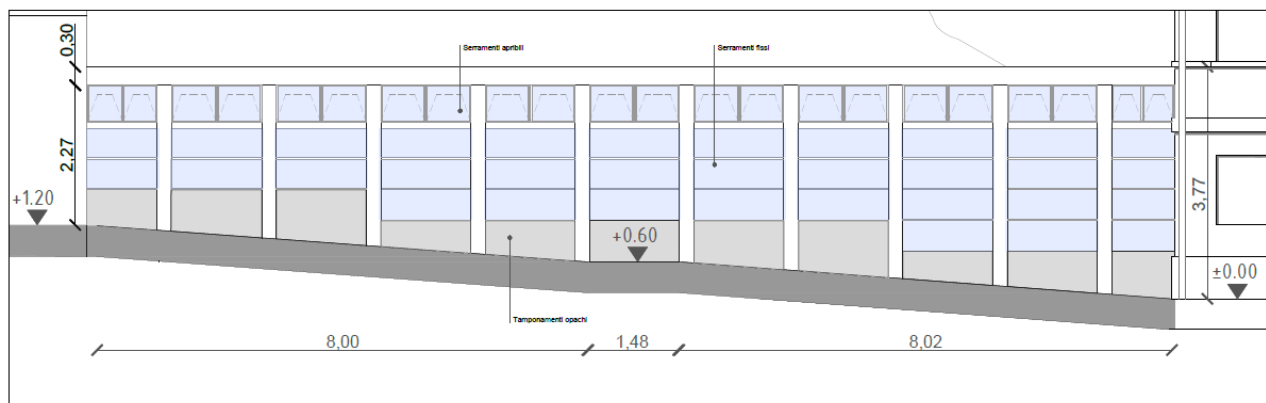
Prospetto nord del passaggio coperto per il collegamento tra la RSA “Casa Insieme” e la struttura oggetto d’intervento
